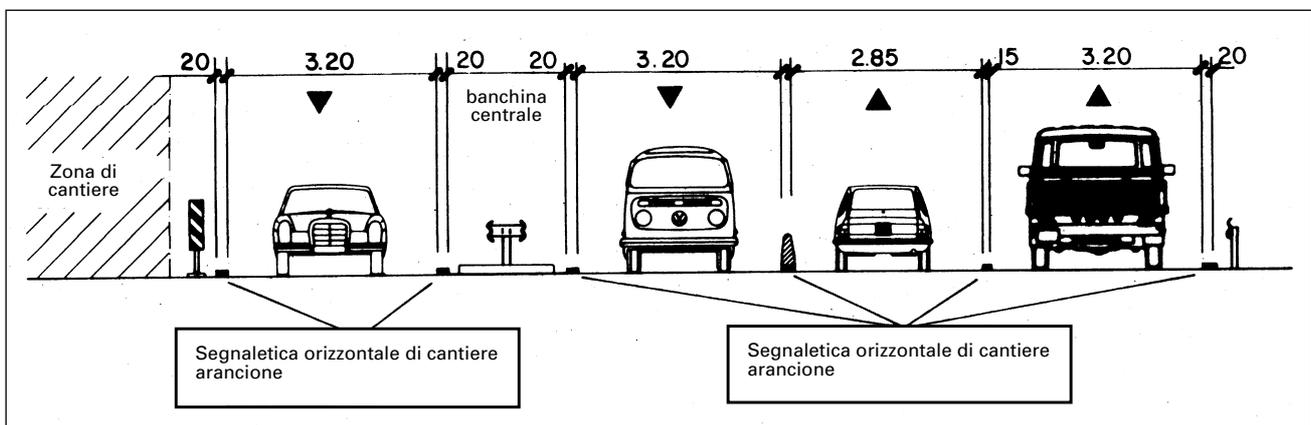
segnaletica provvisoria di cantiere, esempio dove la segnaletica non corrisponde alle direttive della VSS
